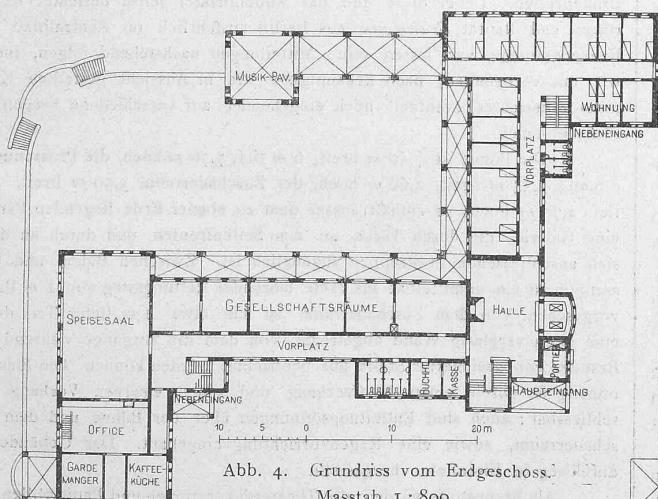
Grundriss vom Erdgeschoss.
